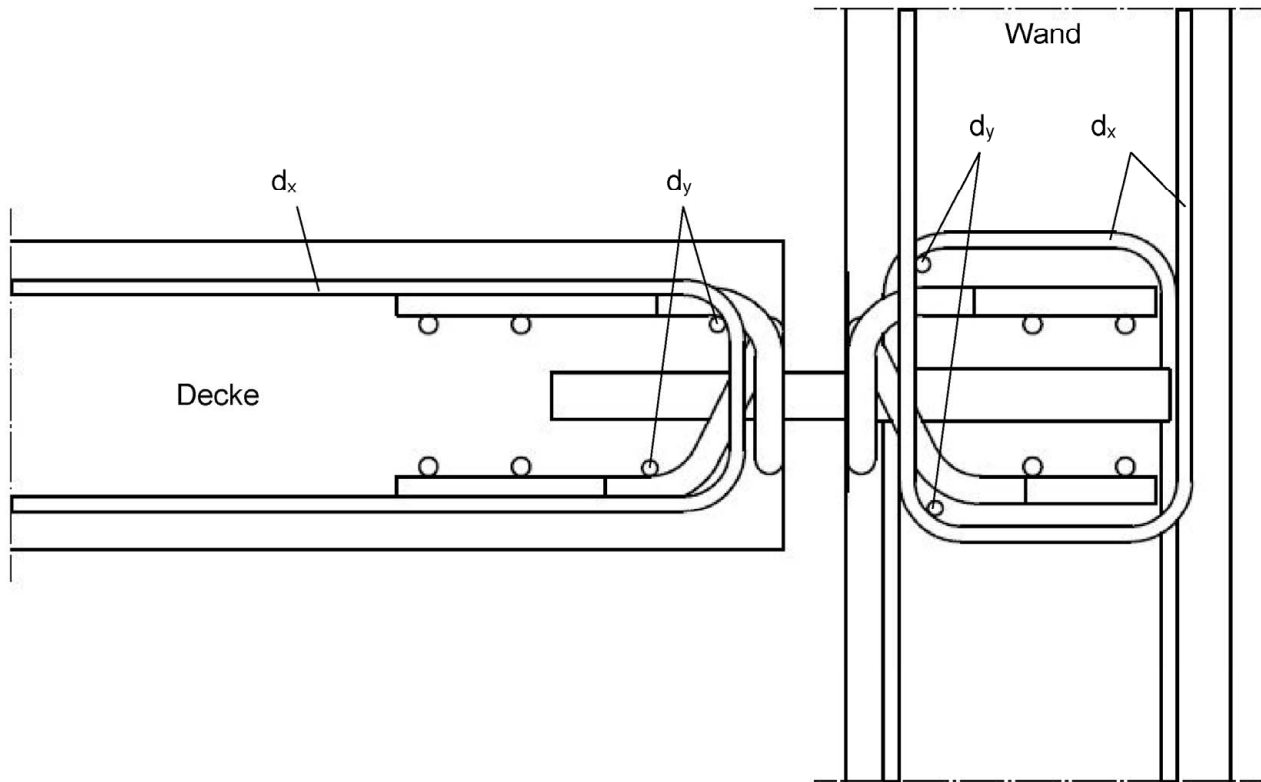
Wandeinbau mit zwei Ankerkörpern
